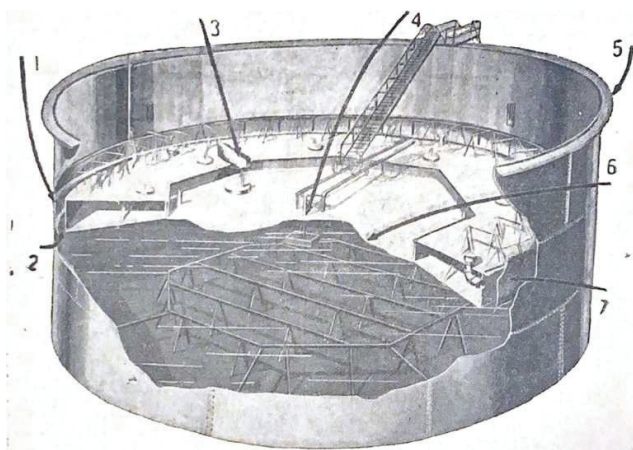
Резервуар с плавающей крышей Д. Виггинса
